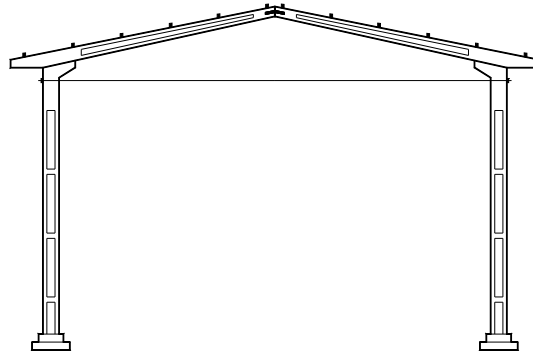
Sistema estrutural de pórticos para telhado de duas águas.
